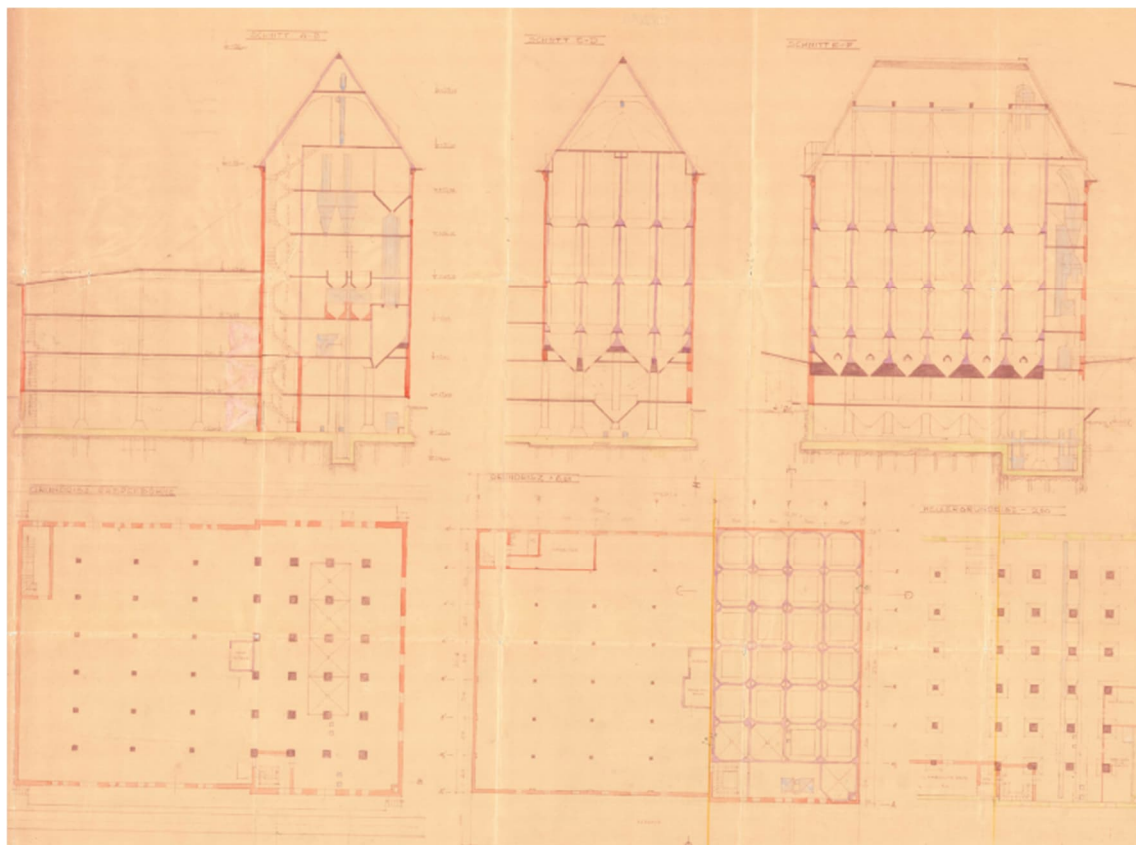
Schnitte und Grundrisse Bestandsgebäude C
